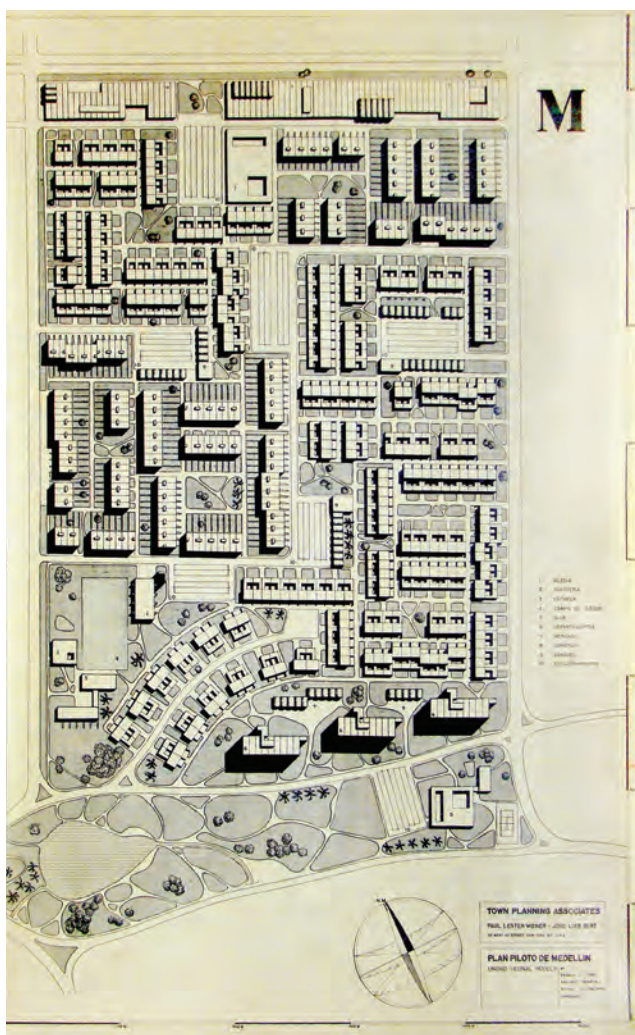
Plano Unidad Vecinal Modelo del Plan Piloto para Medellín.
